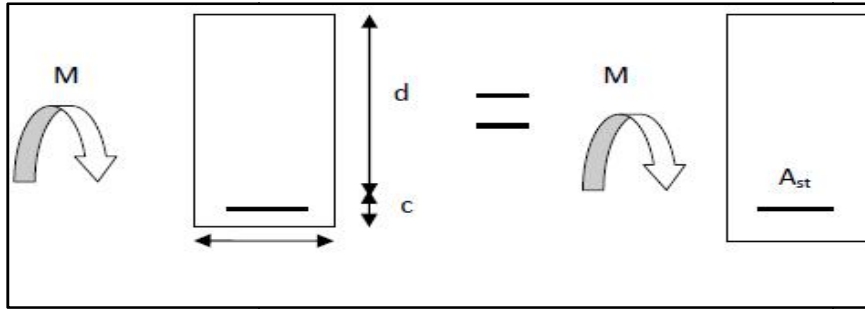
Schéma de Ferraillage des poutres simplement armée
